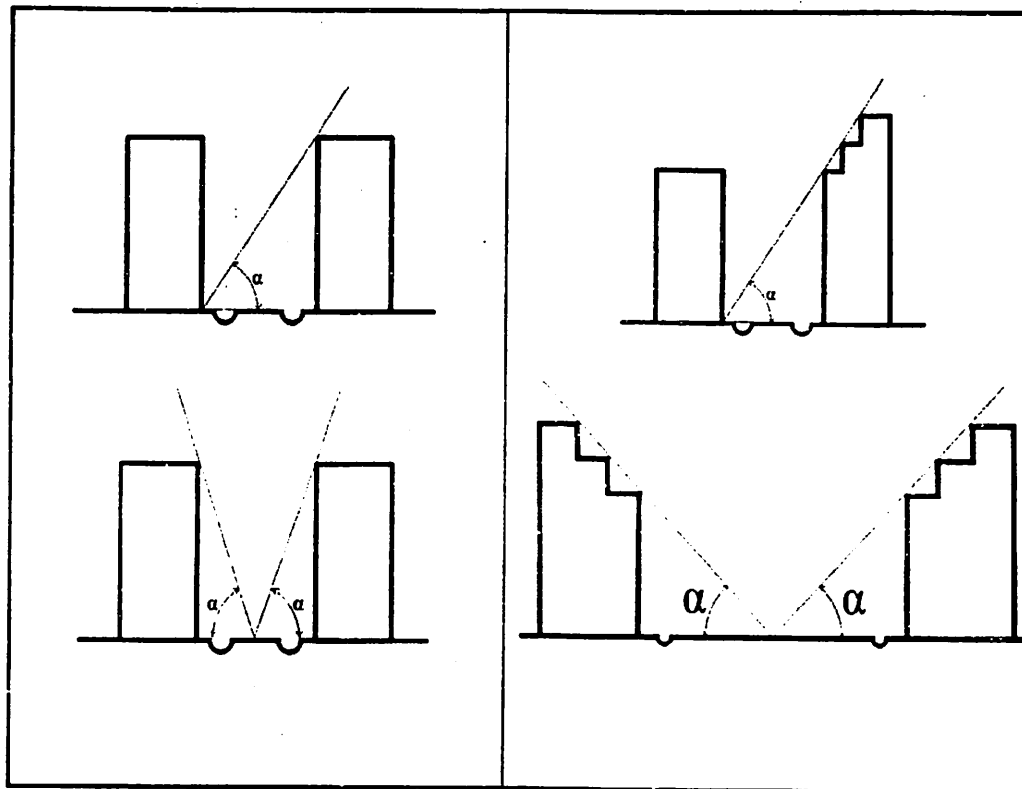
Penentuan ruang antara berdasarkan sudut ruang antara bangunan
